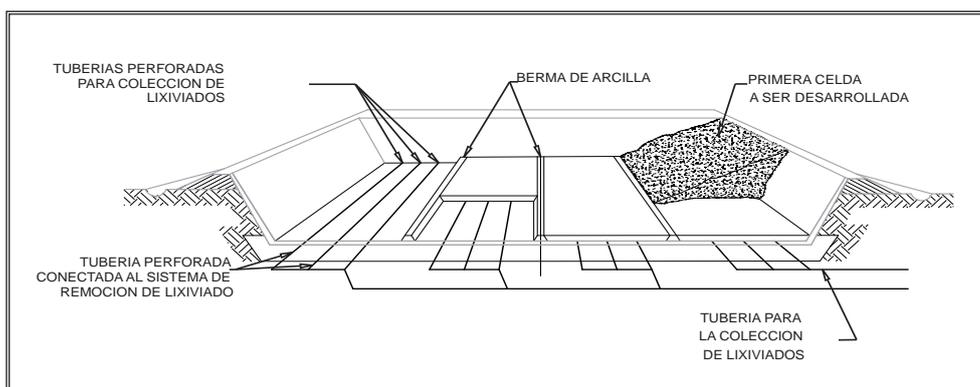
Distribución de tuberías para colección de lixiviado.
